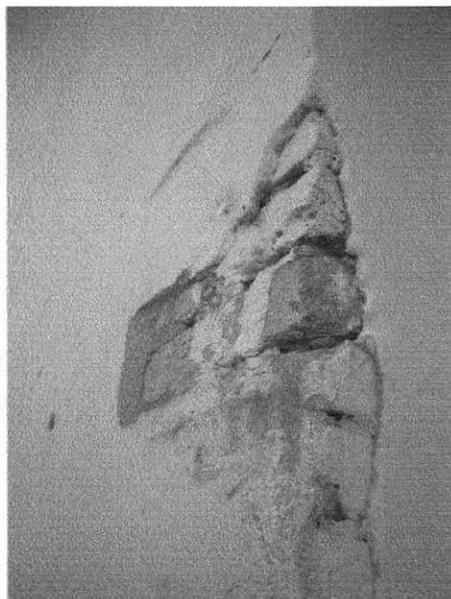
Alvenaria tijolos de adobe, rebocada e caiada.
